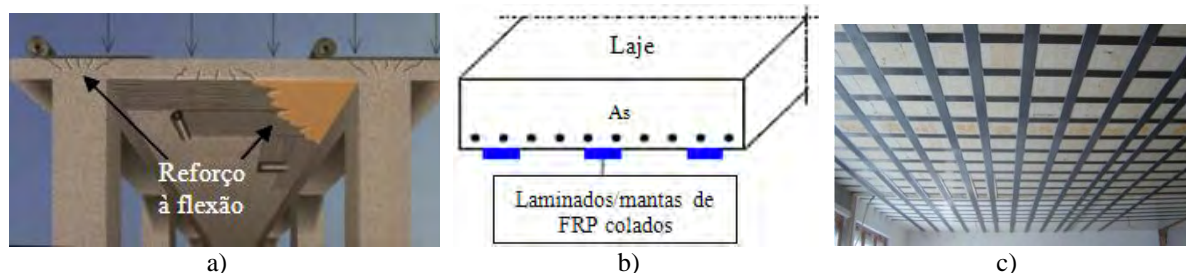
Reforço de lajes à flexão (a) - adaptado de BASF, (2007);
